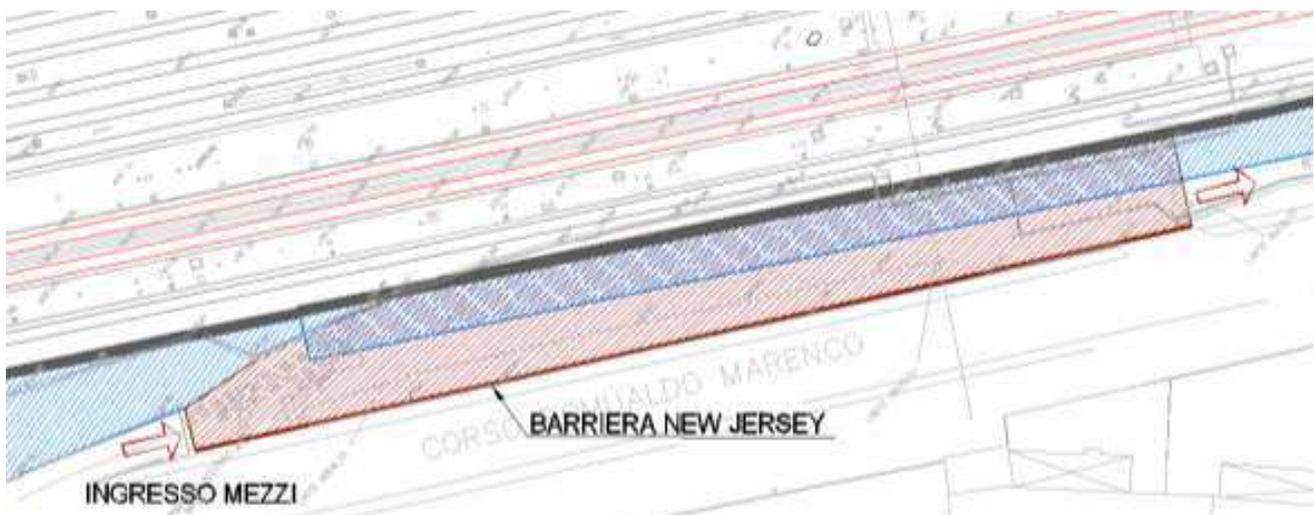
Stralcio planimetrico Area Cantiere – Ingresso mezzi
